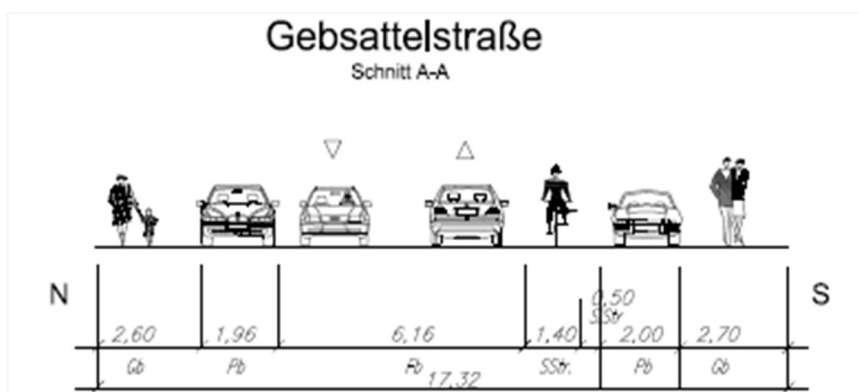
Querschnitt Bestand Gebtsattelstraße Höhe Auer Mühlbach (Quelle: Ing.-Büro Kaltenecker).
